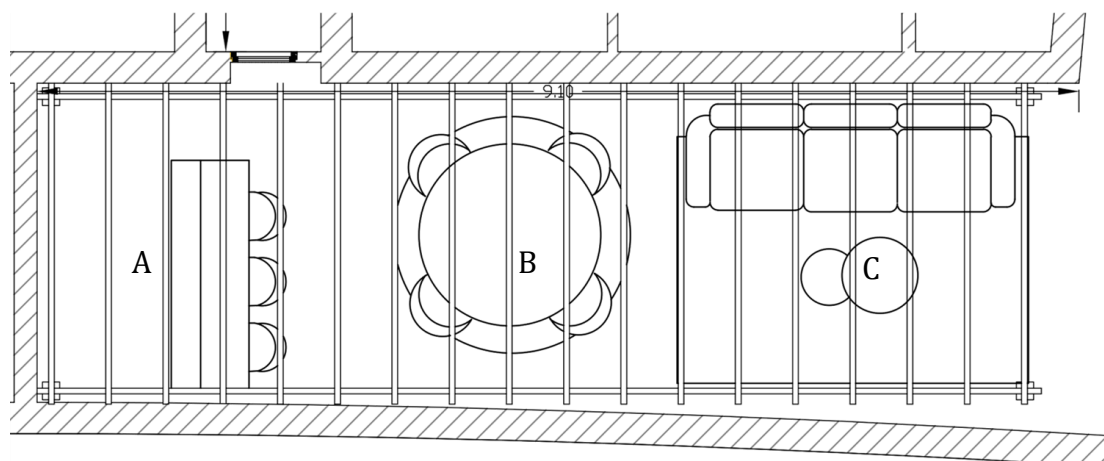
Pormenor Planta Zona lounge e bar. Fonte: autora
